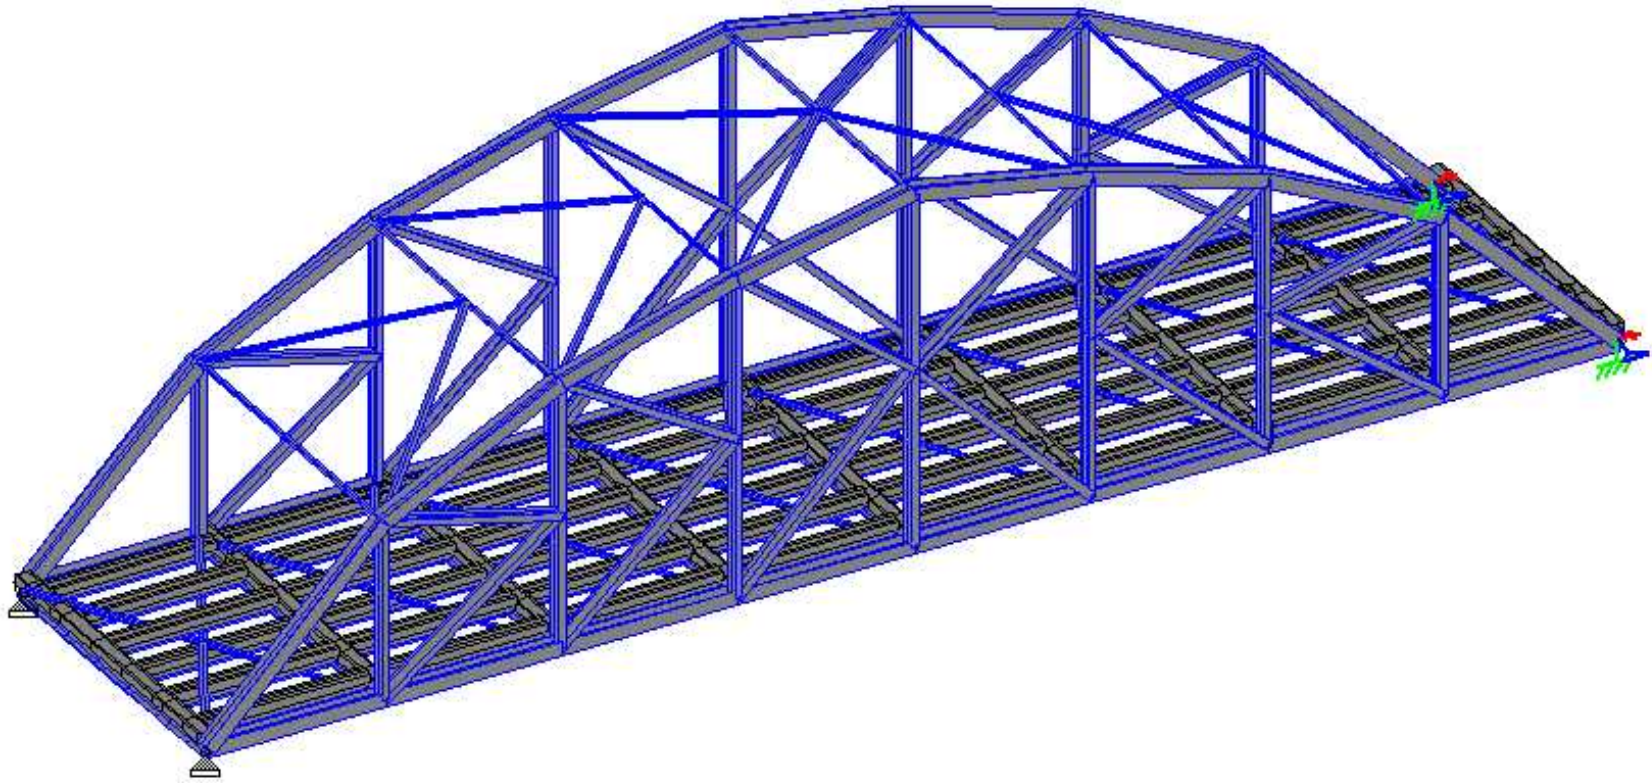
potongan melintang jembatan existing Tipe V - Truss
